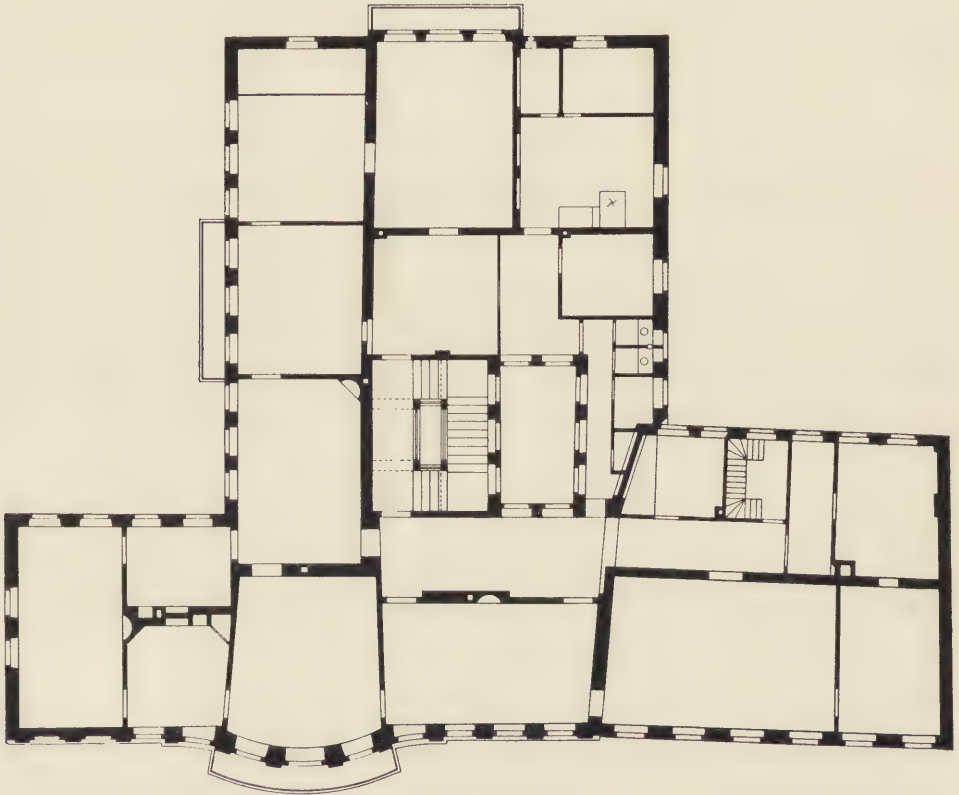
Boxberg'sches Palais, Grundriss des Obergeschosses.
